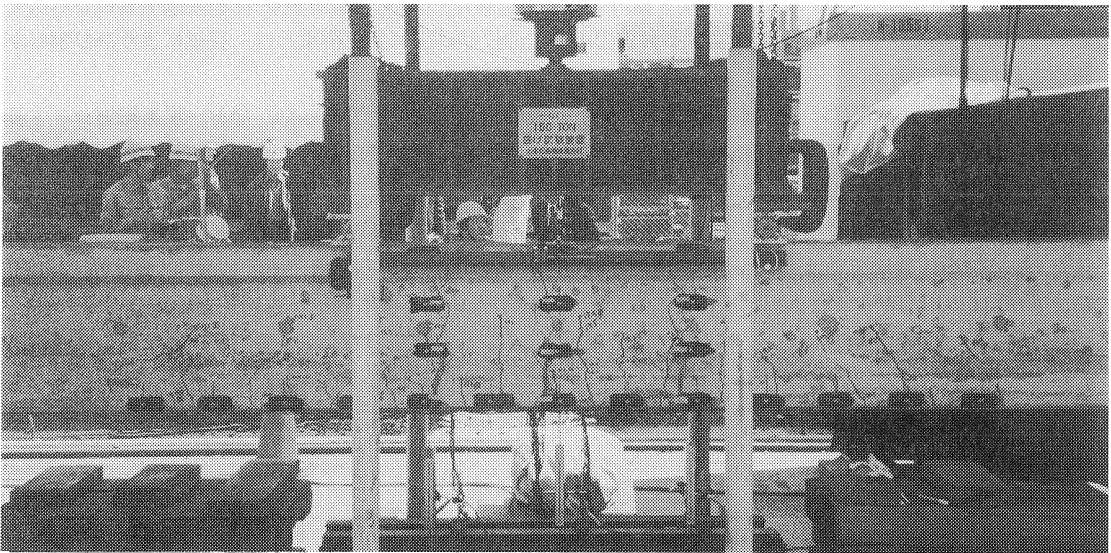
ひび割れ状況写真(炭素繊維プレート補強桁)
